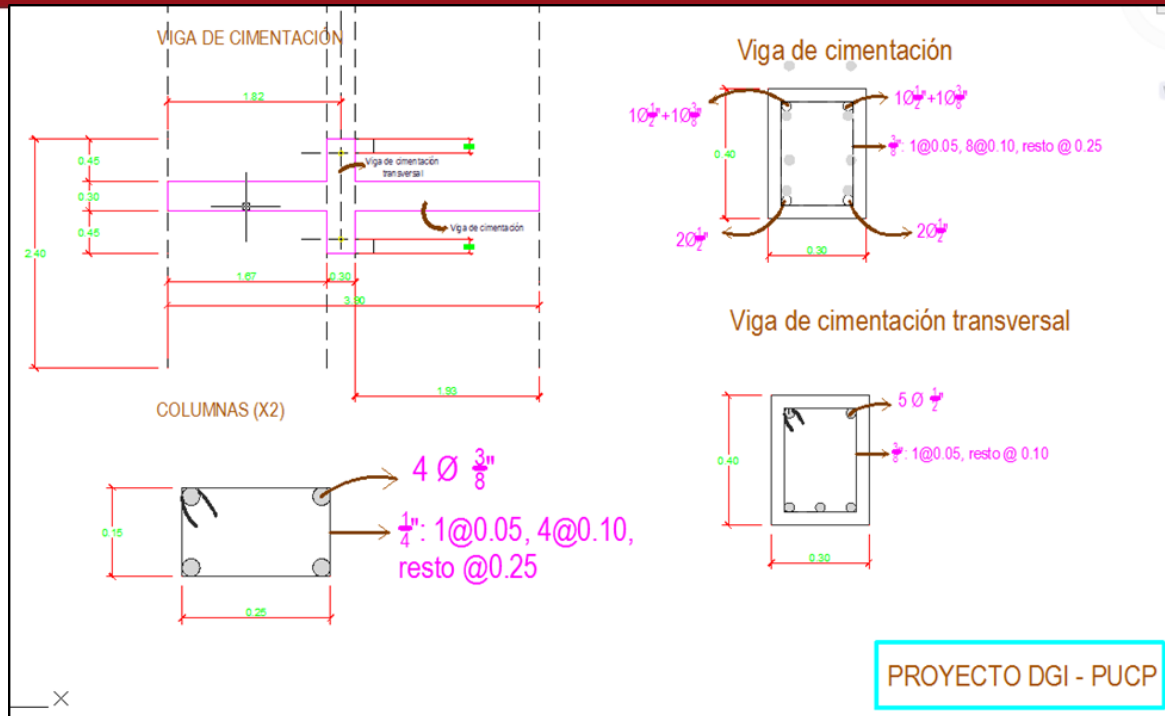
Refuerzos de Acero en Muro de Albañilería M33%(m)
